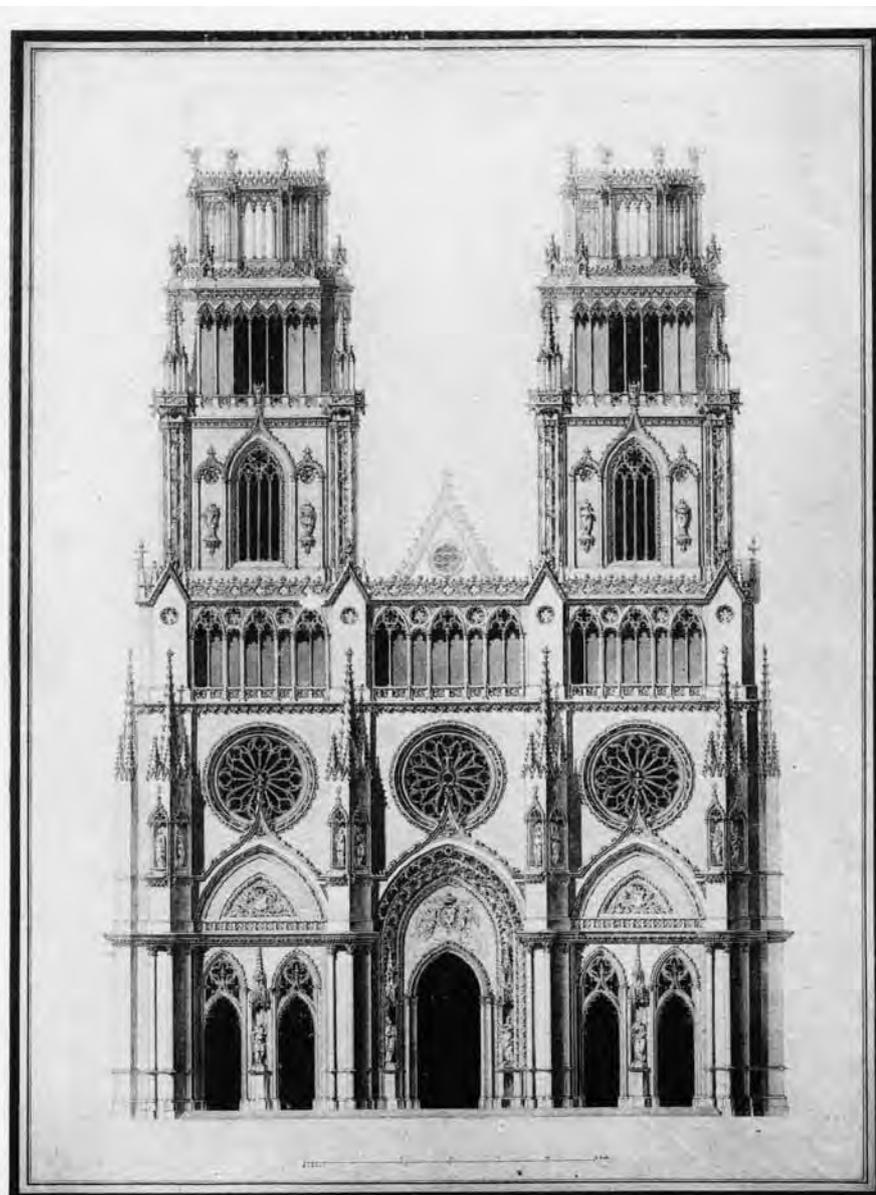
Le projet de Trouard. Élévation de la façade.
